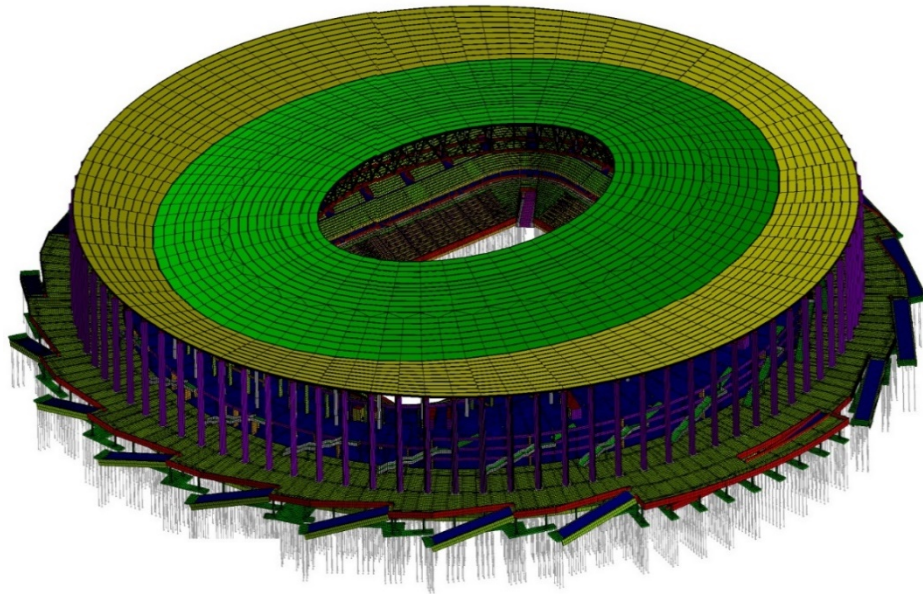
Конечноэлементная модель полной системы «основание – железобетонные конструкции фундаментов и трибун – металлические конструкции покрытия» стадиона в Нижнем Новгороде.
